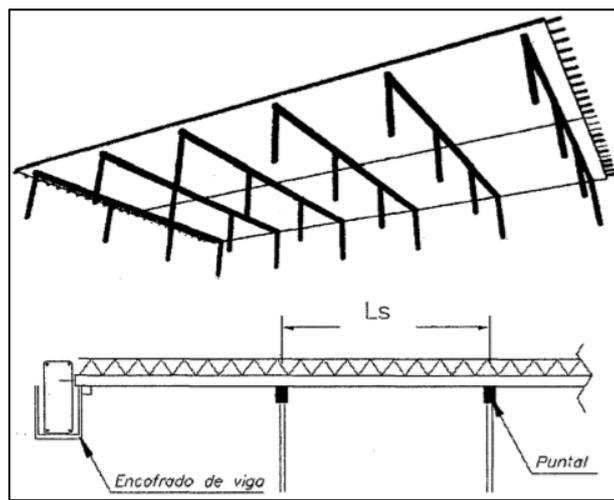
Sección típica de apuntalamiento de prelosa prefabricada.
